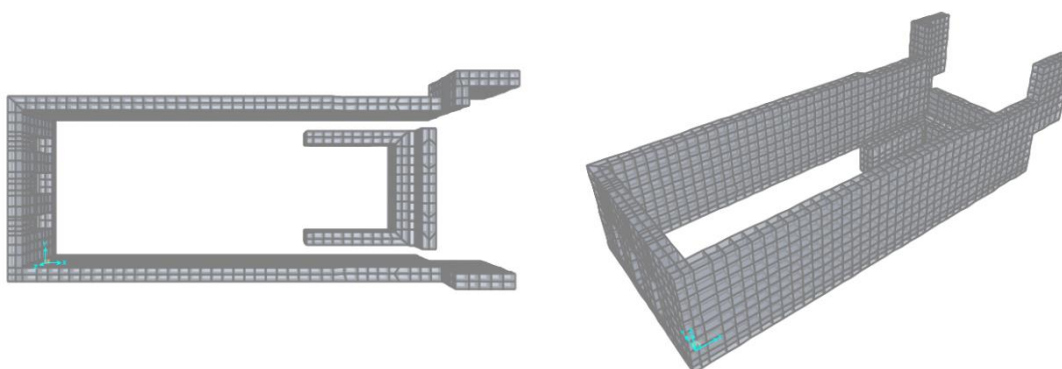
Modelo em 3D das paredes de alvenaria (CSI America, 2014)
